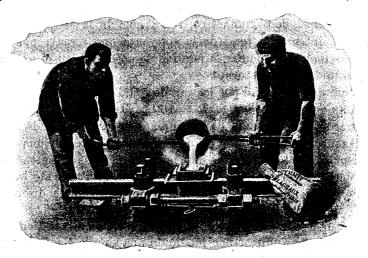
Soldadura de los carriles, sistema Goldschmidt.
